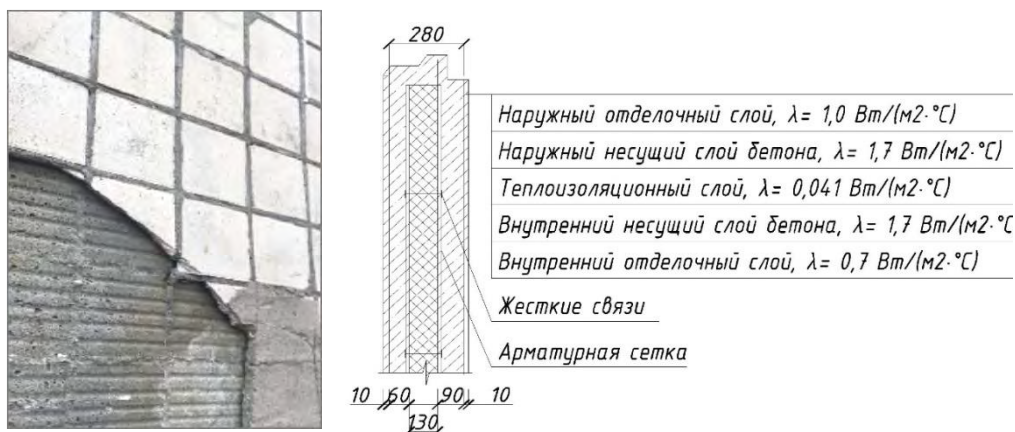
Фото и разрез стены из трехслойной ж/б панели до ремонта
